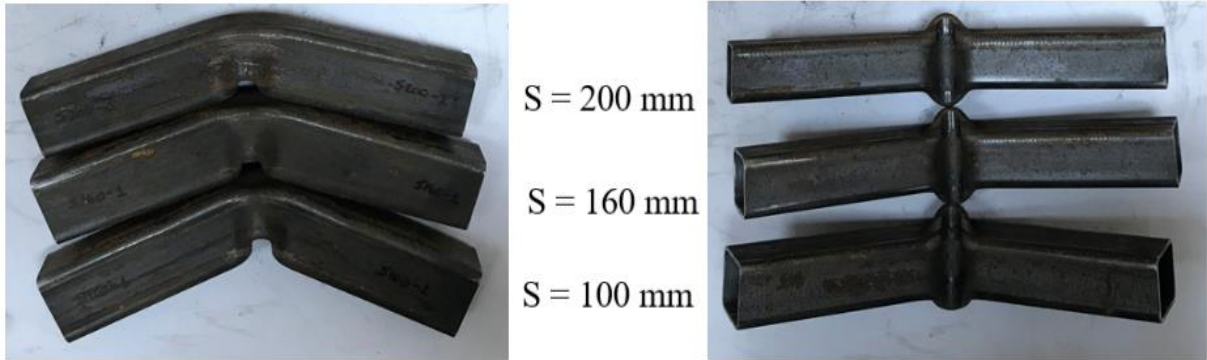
Boru kesit profillerin üç farklı destek aralığında deforme olmuş halleri
